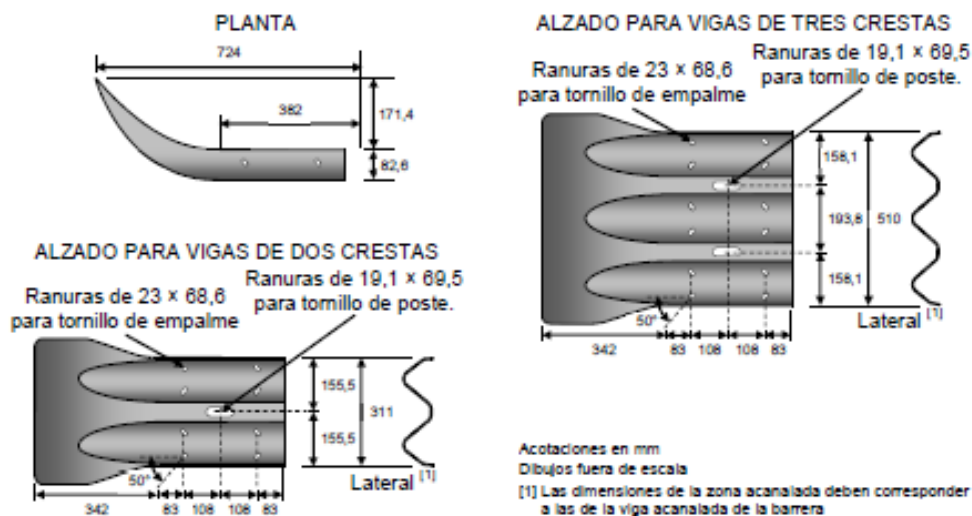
Secciones terminales sencillas para vigas acanaladas de dos y de tres crestas
